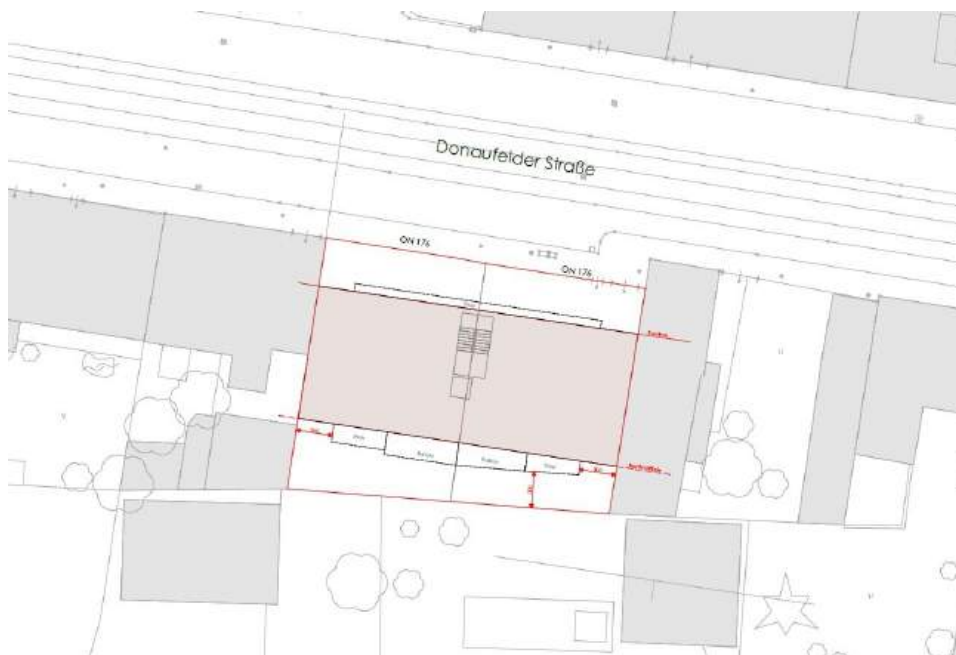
Lageplan 22. Donaufelder Straße 174-178
